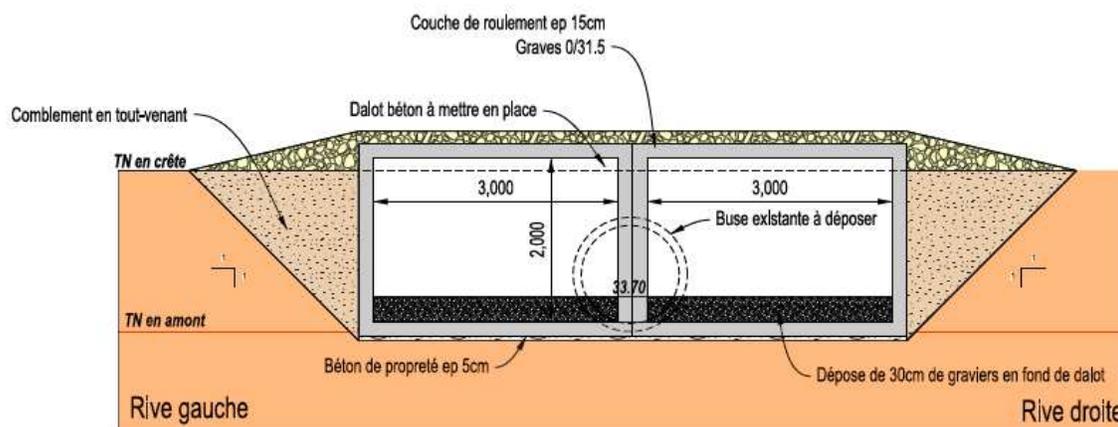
coupe du double dalot sur le secteur de Moulin Jasnot/Pont des Planches (plan n°15)
